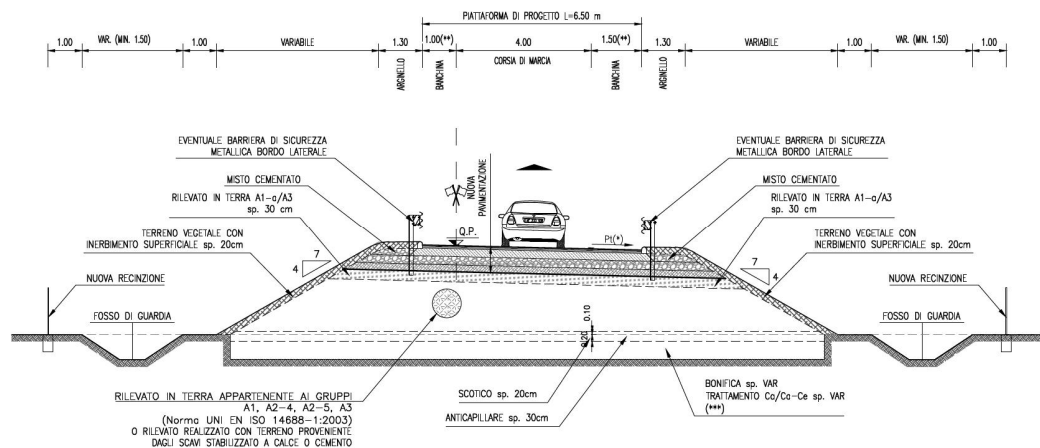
Sezione tipo rampa monodirezionale in rilevato
